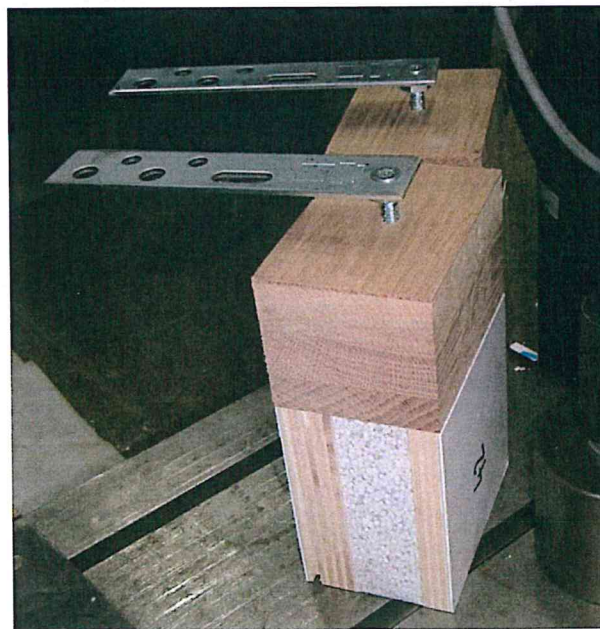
Probekörper Nr. 11 und Nr. 12. Die Druckkraft wird über das Holzrahmenprofil (Eiche) in das SDP eingeleitet. Die Einschraubtiefe beträgt $l = 30$ mm. Für die Montage der Fixierschraube wurde mit $\varnothing = 5$ mm vorgebohrt
